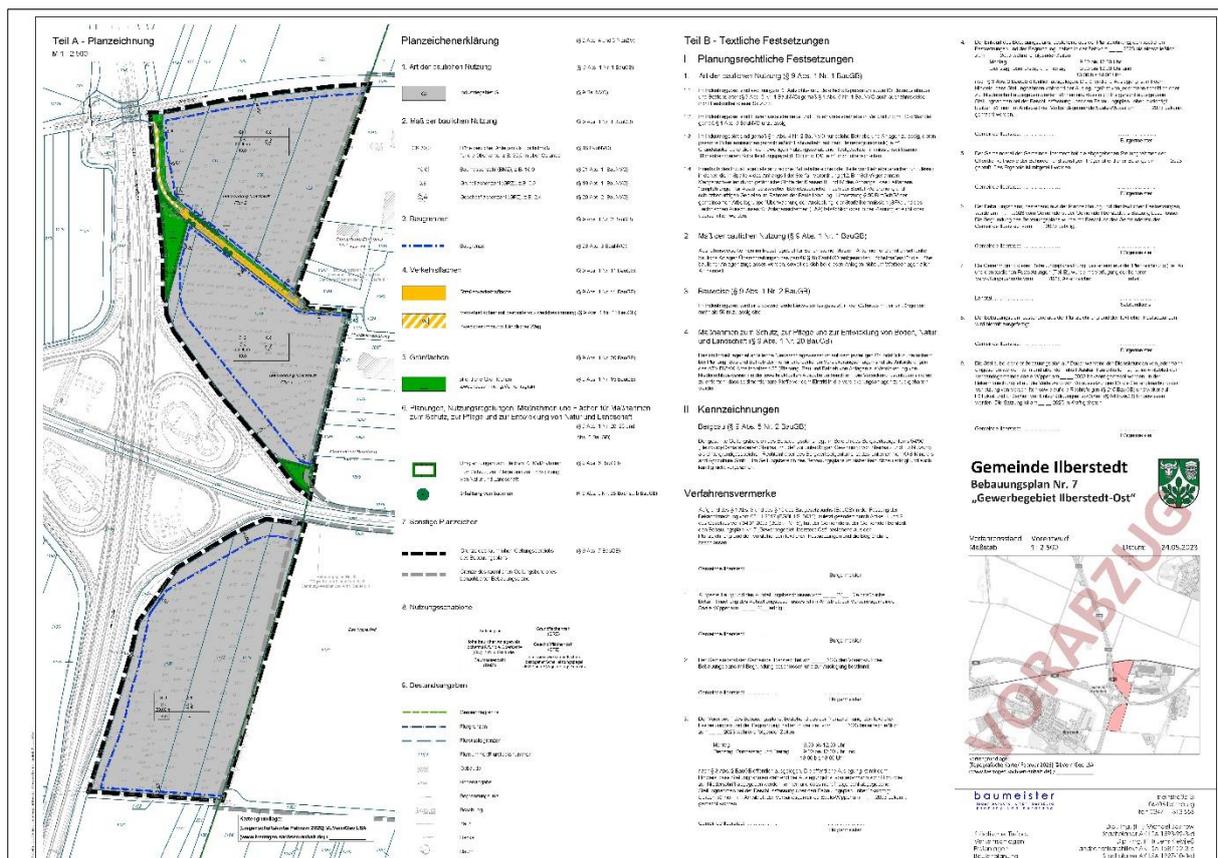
Vorentwurf der Planzeichnung zum Bebauungsplans Nr. 7 (gemäß /57/)
